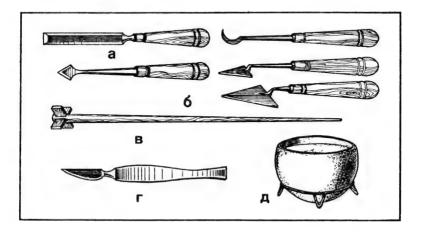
Основные инструменты для выполнения резьбы по гипсу: а— стамеска; б— скребки для выборки фона; в— мутовка (для размешивания раствора); г— скальпель; д— сосуд для замешивания раствора
